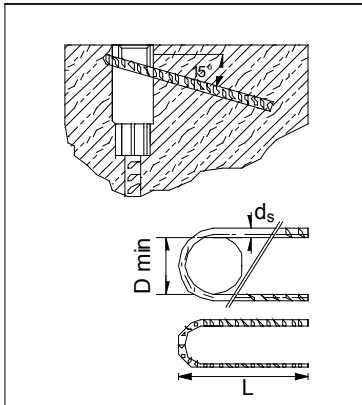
Zusatzbewehrung Schrägzug - Beispiel Liste 31
